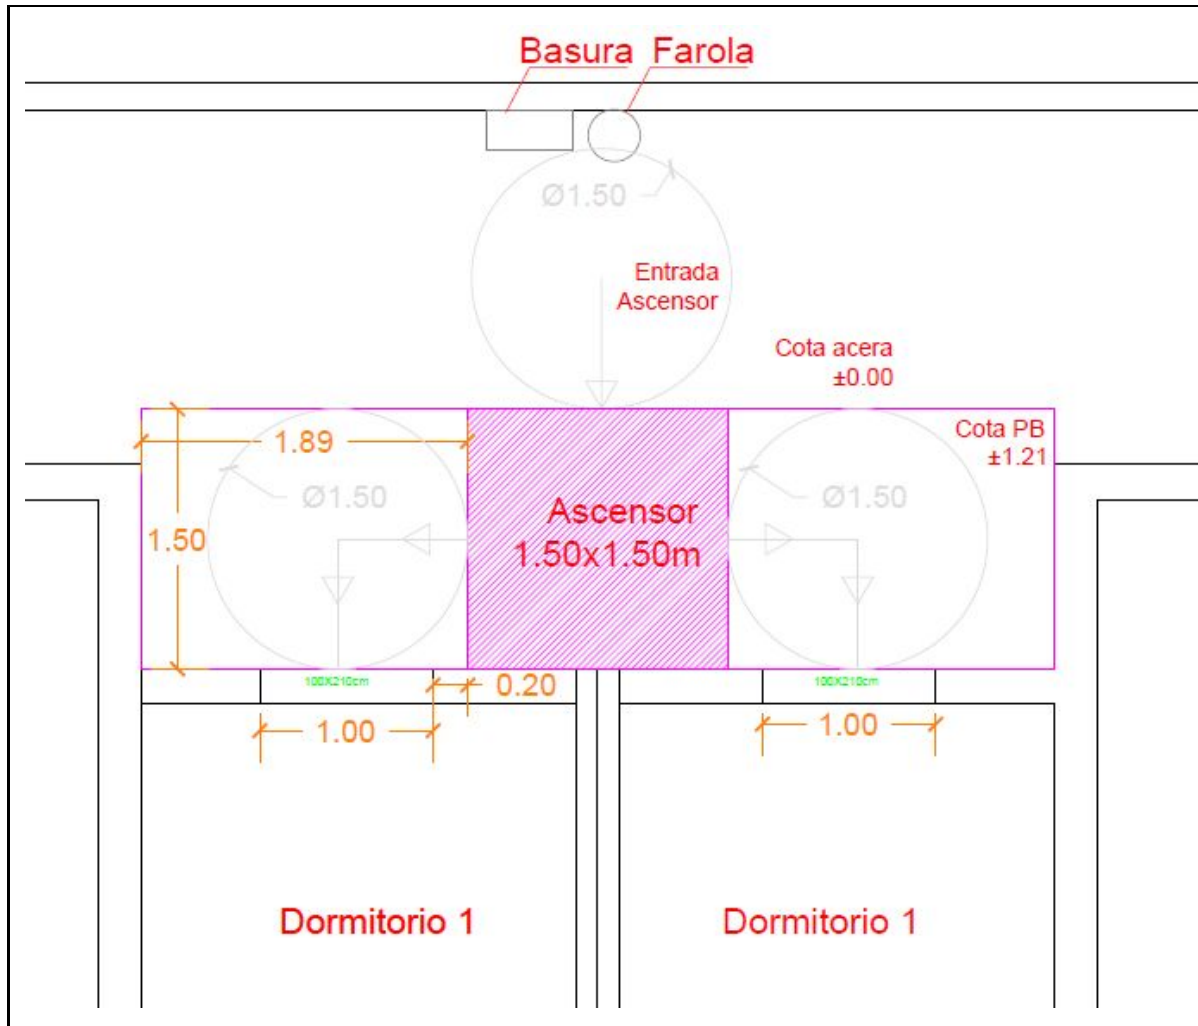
Justificación plataforma en planta baja (Fuente: Anejo A)
